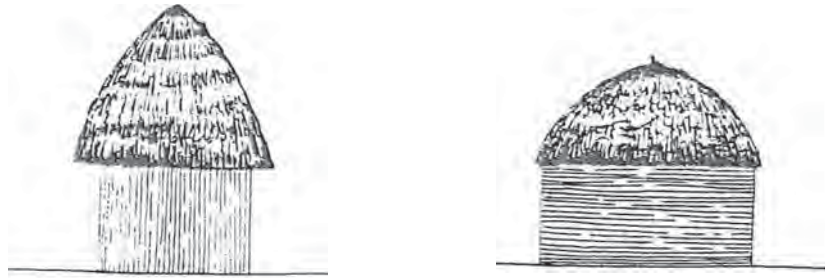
Tipología de cabañas africanas. Construcciones aisladas con planta cuadrada.
